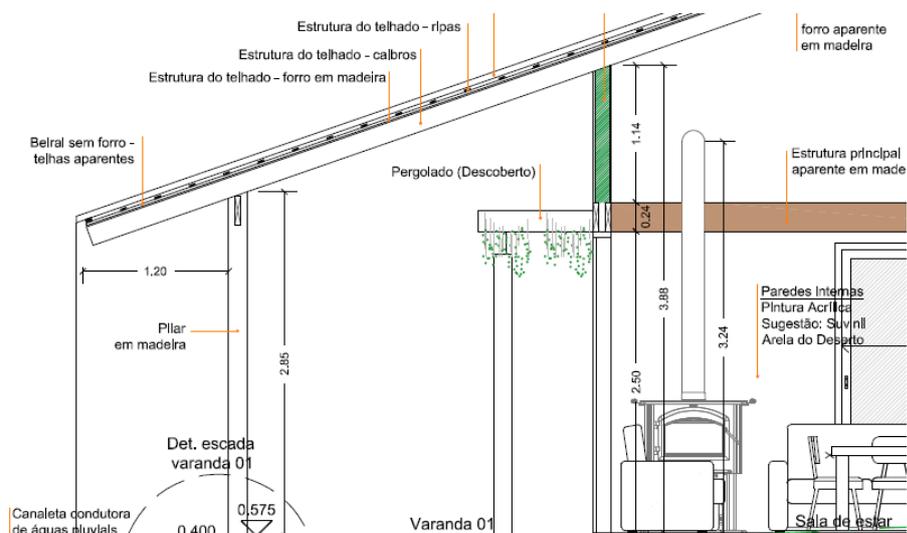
Paredes acima da viga, em tijolo baiano – vista em corte
